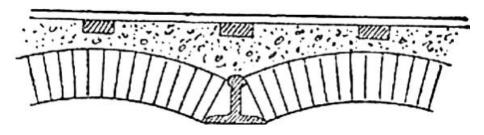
Кладка прусских сводов по рельсам, 1903 г. [12] Fig. 15. Prussian masonry vaulting on rails, 1903 [12]
